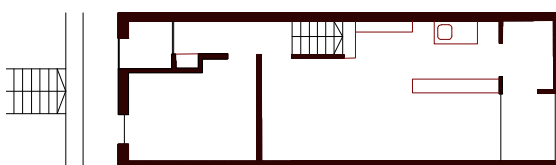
Planta tipo Bairro da Bouça - SAAL
